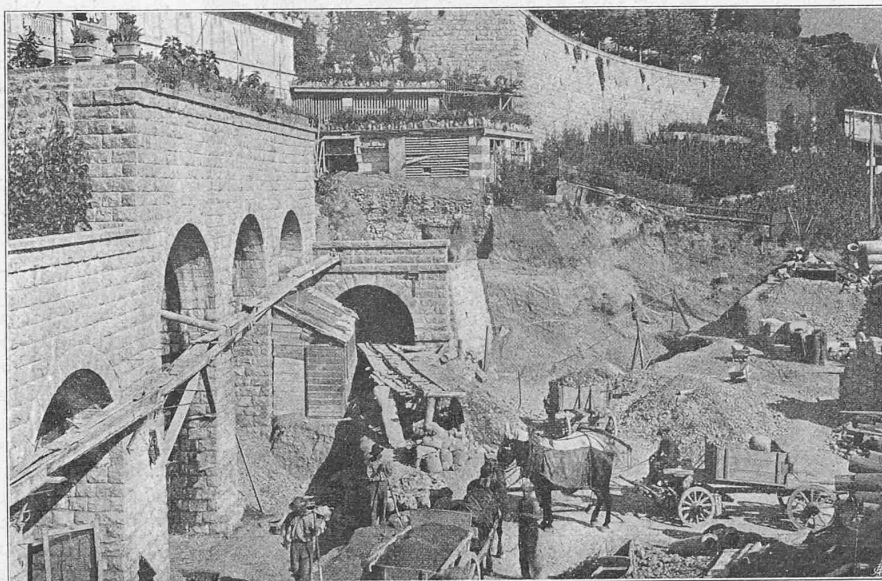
Stützmauer und Tunnelleingang am östlichen Ende des Bahnhofs Montreux.
